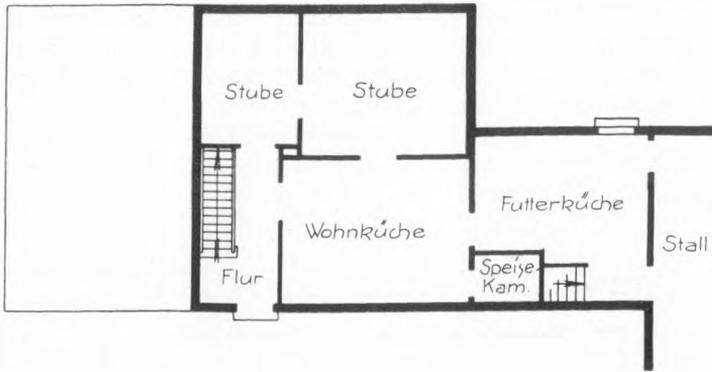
Wohnhaus mit 3 Wohnräumen im Erdgeschoß durch Futterküchenzwischenbau mit dem Stall verbunden. Ausbau von 1 Zimmer im Dachgeschoß möglich. Durch Erweiterung können je 2 Zimmer im Erd- und Dachgeschoß gewonnen werden.
